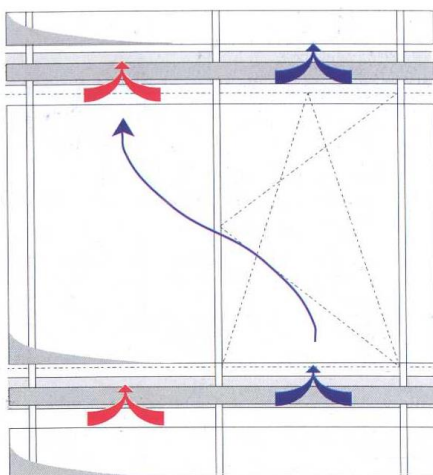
Vista frontal Corridor Facade. Funcionamiento de la ventilación cruzada (A4)
